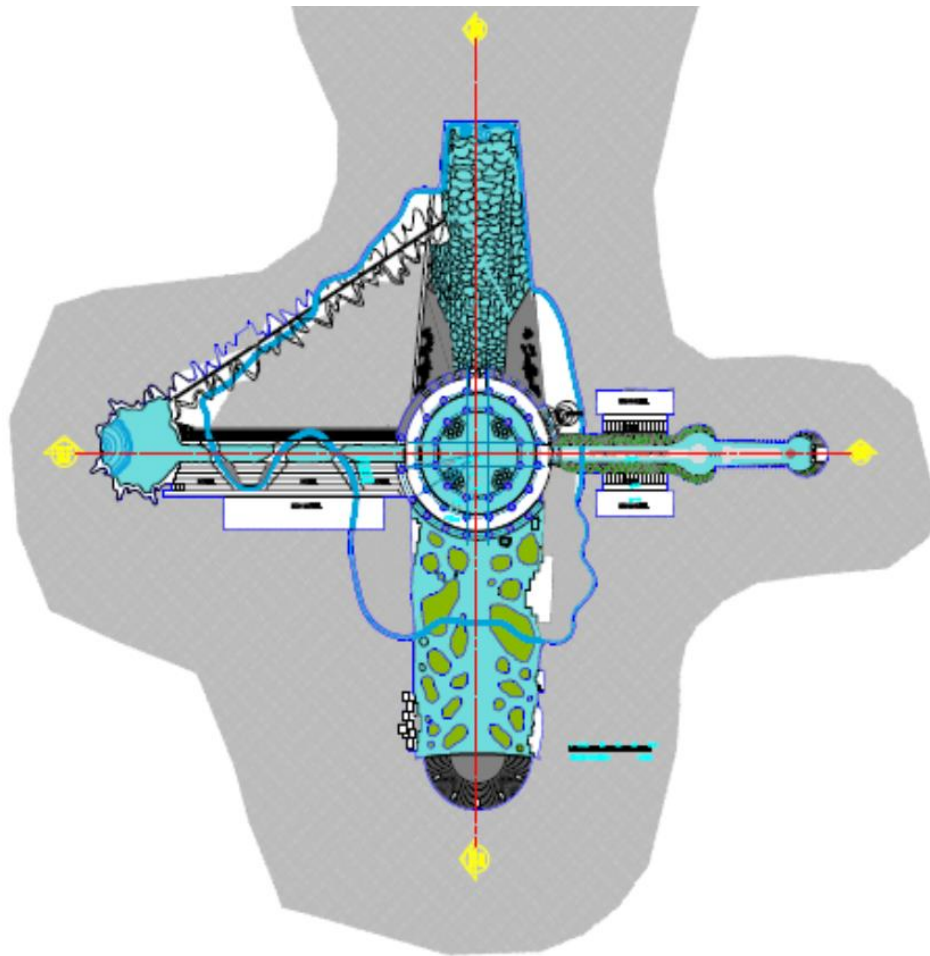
Planta de conjunto: -10m. Profundidad Para mayor detalle ver anexo cartográfico versión AutoCAD
